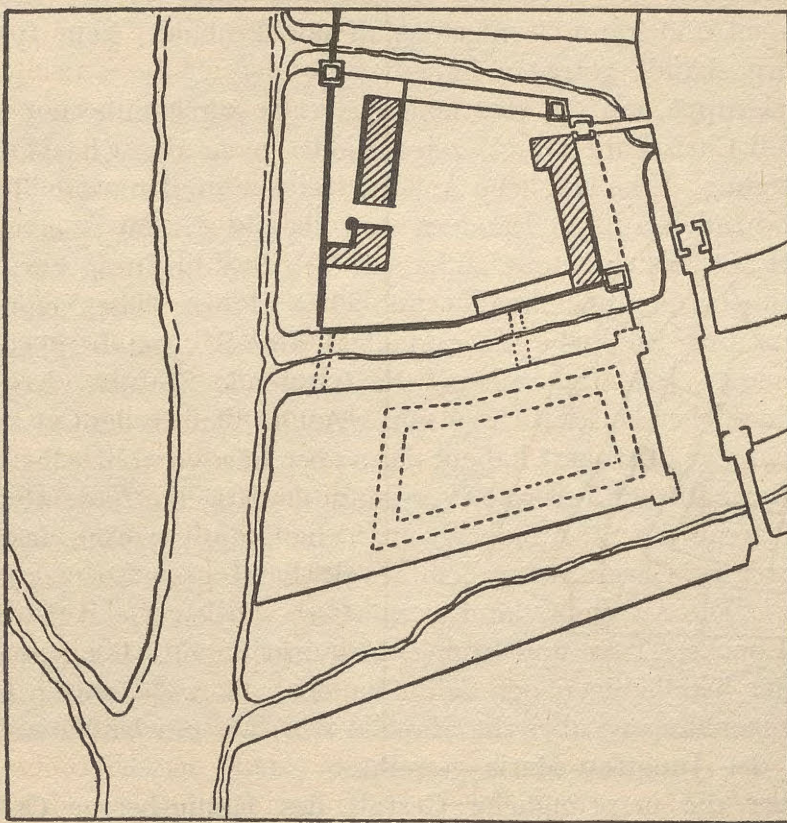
Burg Elbing. Lageplan nach Steinbrecht.
